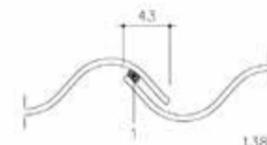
Pose du cordon d'étanchéité dans le recouvrement transversal [profil ECOLOR]
